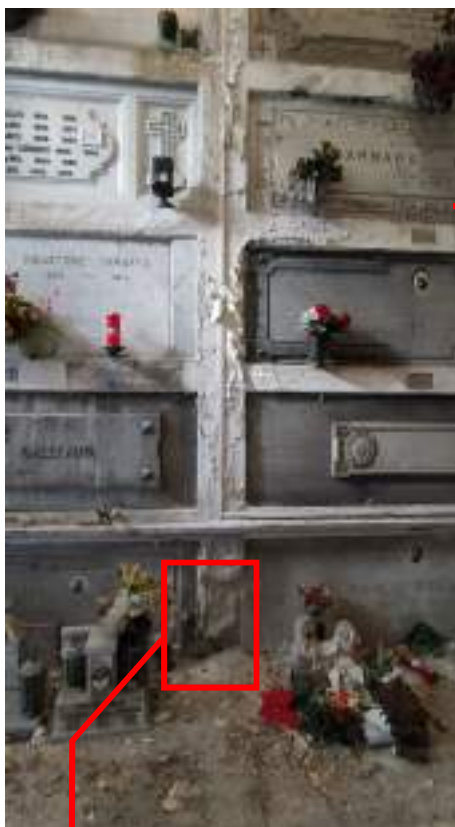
Vecchia Galleria vista dall'ingresso laterale
